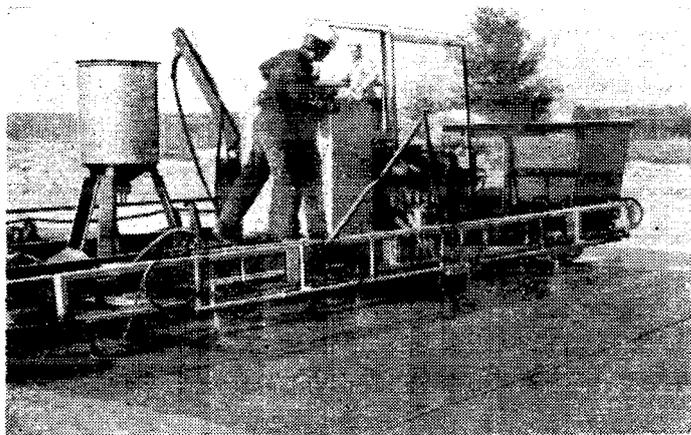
Установка для распыления депрессора испарения с пятью подвижными пистолетами-распылителями на общей раме. Защитные кожуха факелов сняты. Распылители перемещаются поперек покрытия возвратно-поступательно при помощи вертикального механизма
